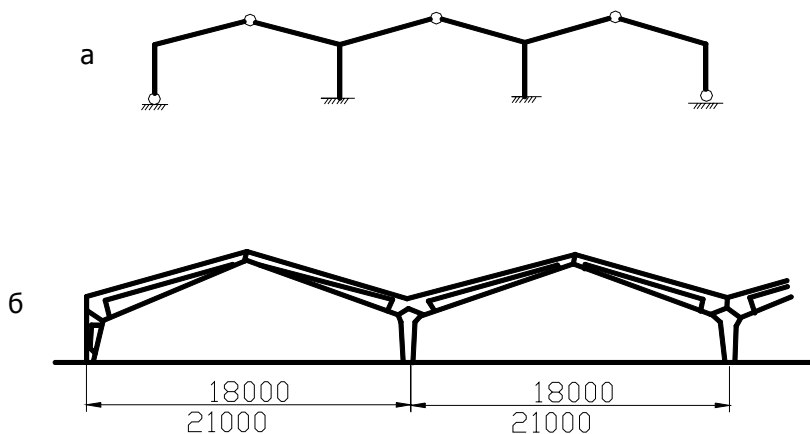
Багатопрогоновий рамний каркас з залізобетонних лінійних елементів по типу РЖС (к.УкрНДІДіпросільгосп, ЦНИИЭПсельстрой):
